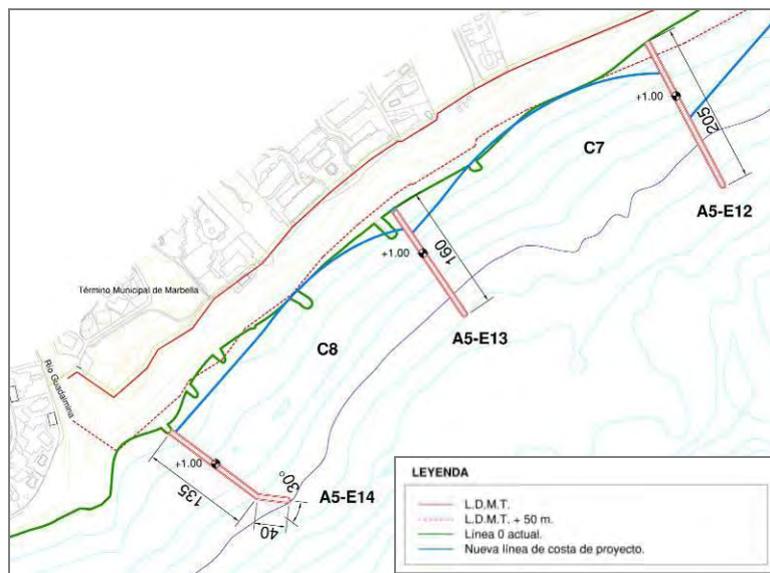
Planta Alternativa 5. Celdas C7-C8.
